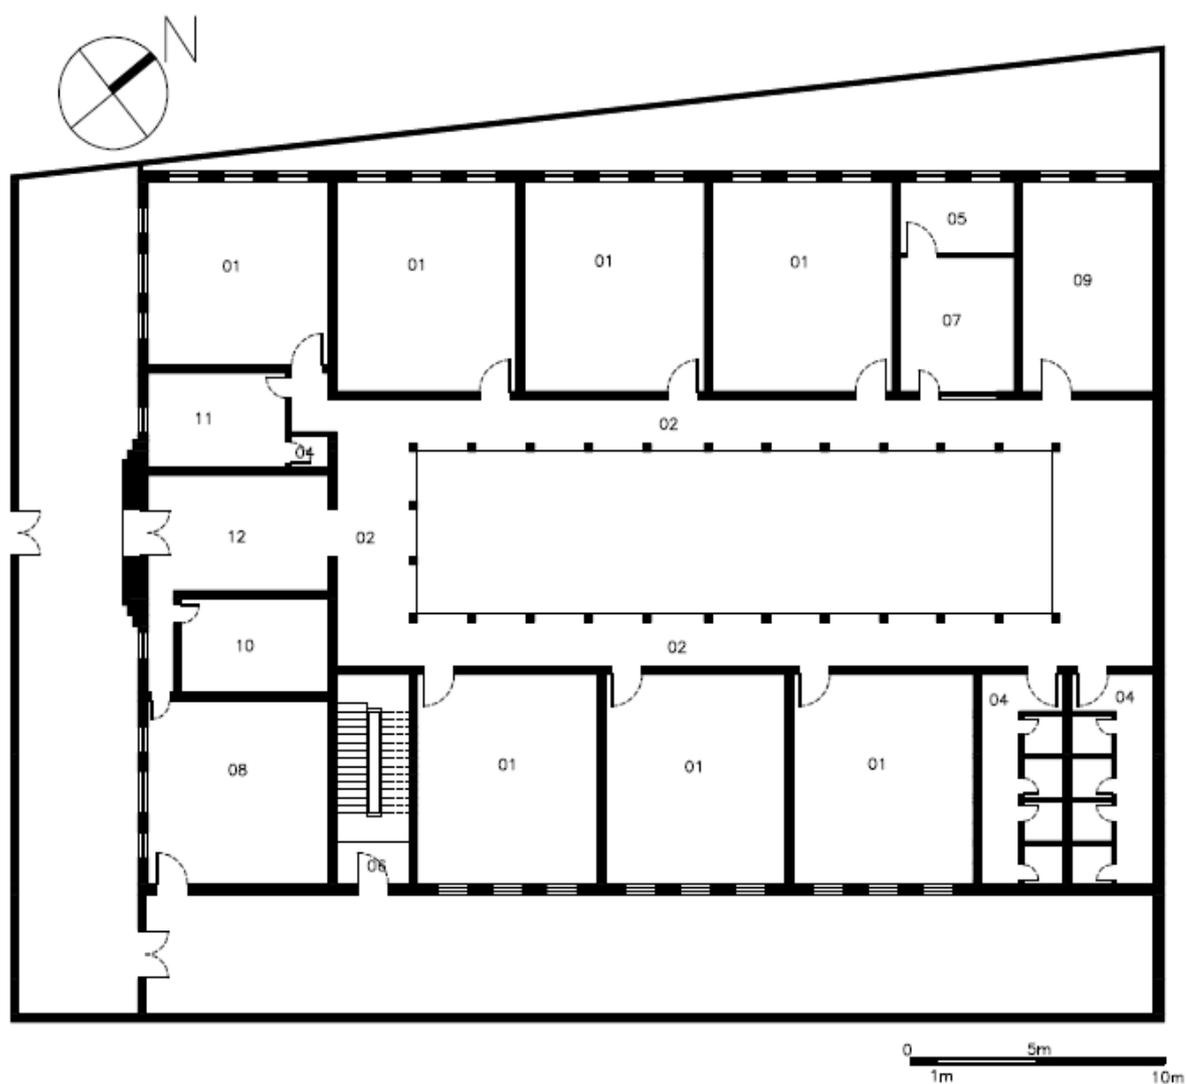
Planta do pavimento térreo do Grupo Escolar Prof. Arruda – Sobral
